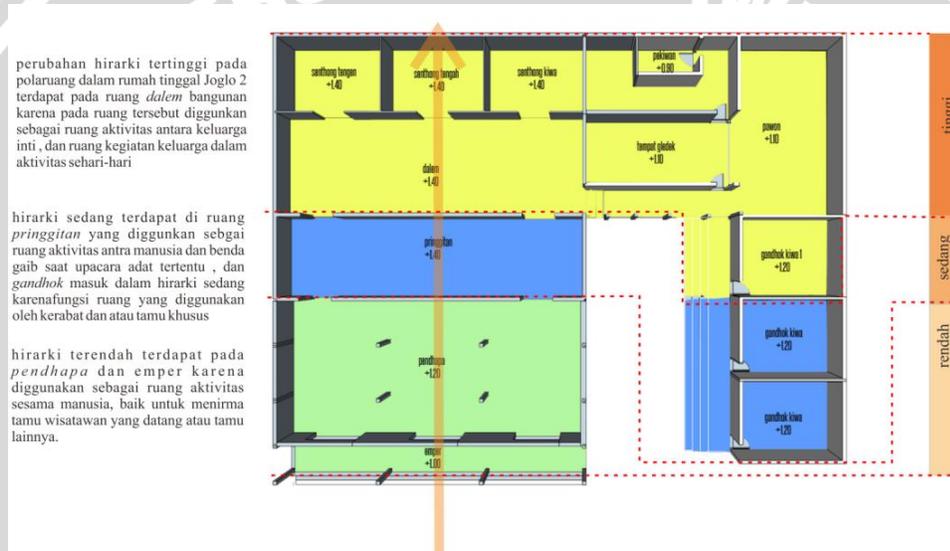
Elemen pembentuk ruang zona privat studi kasus J2
